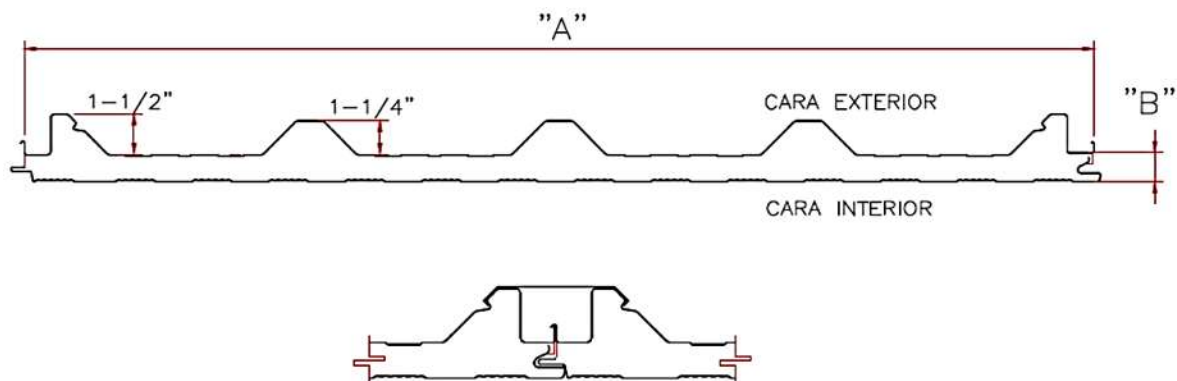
Cubierta del tercer nivel, edificio “C (fuente: autor).
